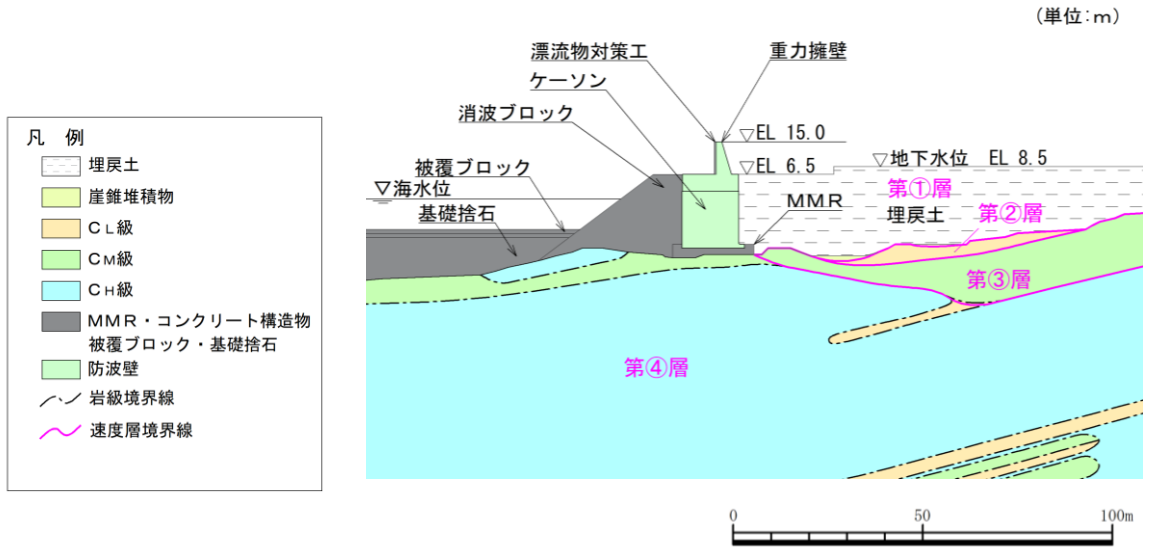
防波壁（波返重力擁壁）の横断面図（①-①断面）
